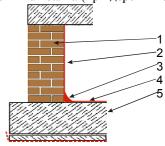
Гидроизоляция существующей стены или дымового канала при напоре грунтовой воды или влажности без отложений на поверхности соли:
